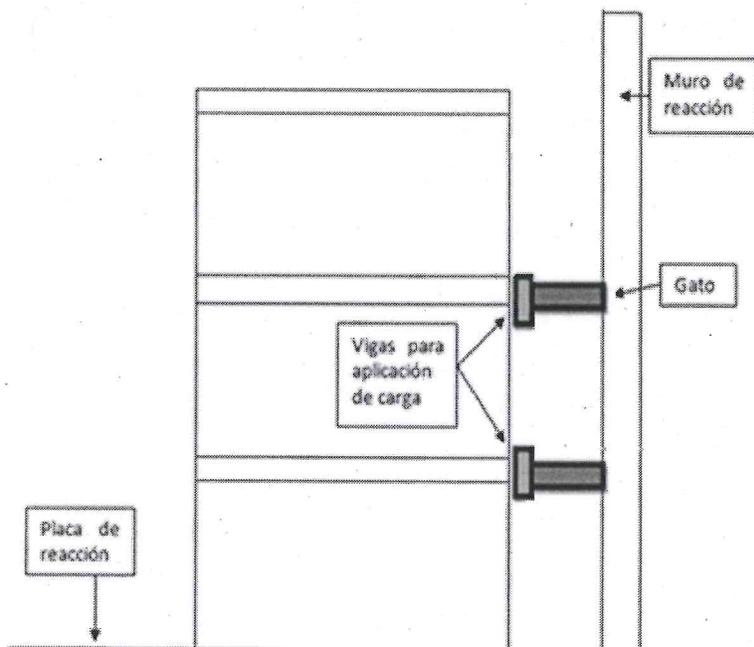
Esquema en planta de la configuración para la prueba estática de carga lateral.
